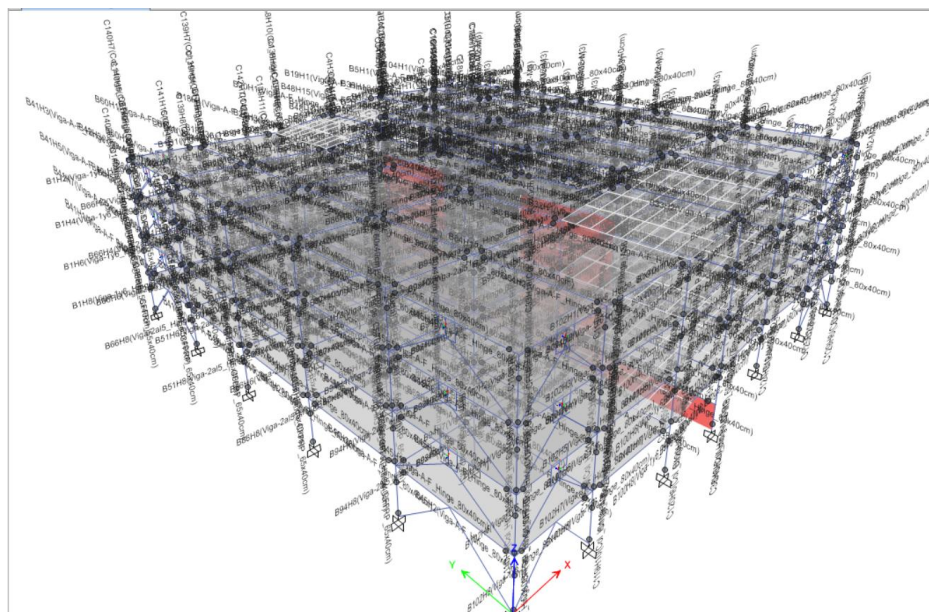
Hinges en todos los elementos estructurales del edificio.
